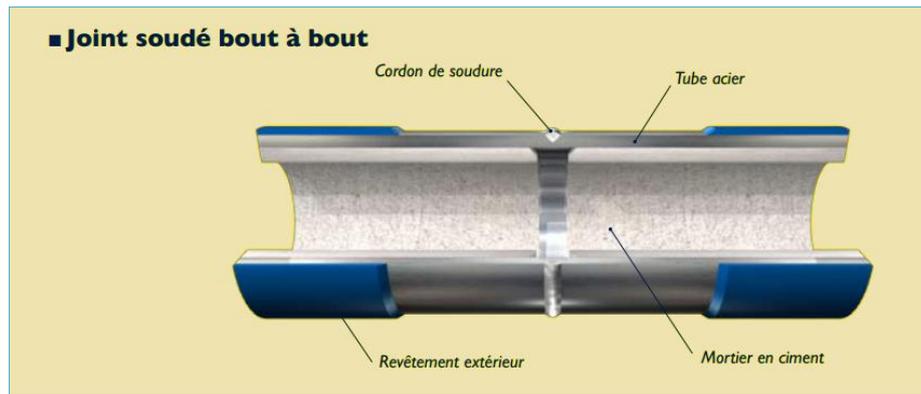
Mode de soudage bout à bout du tube en acier [2]
